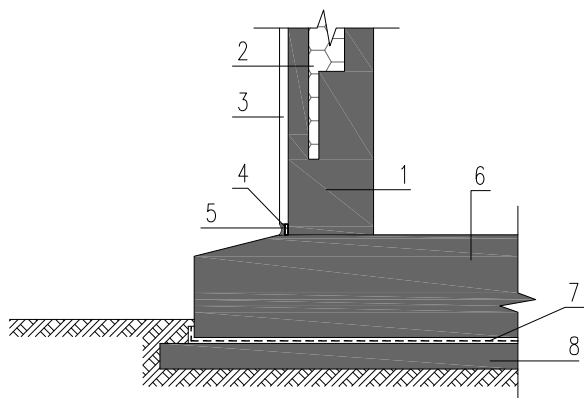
基础、地面和首层外墙防水（防潮）构造示意
